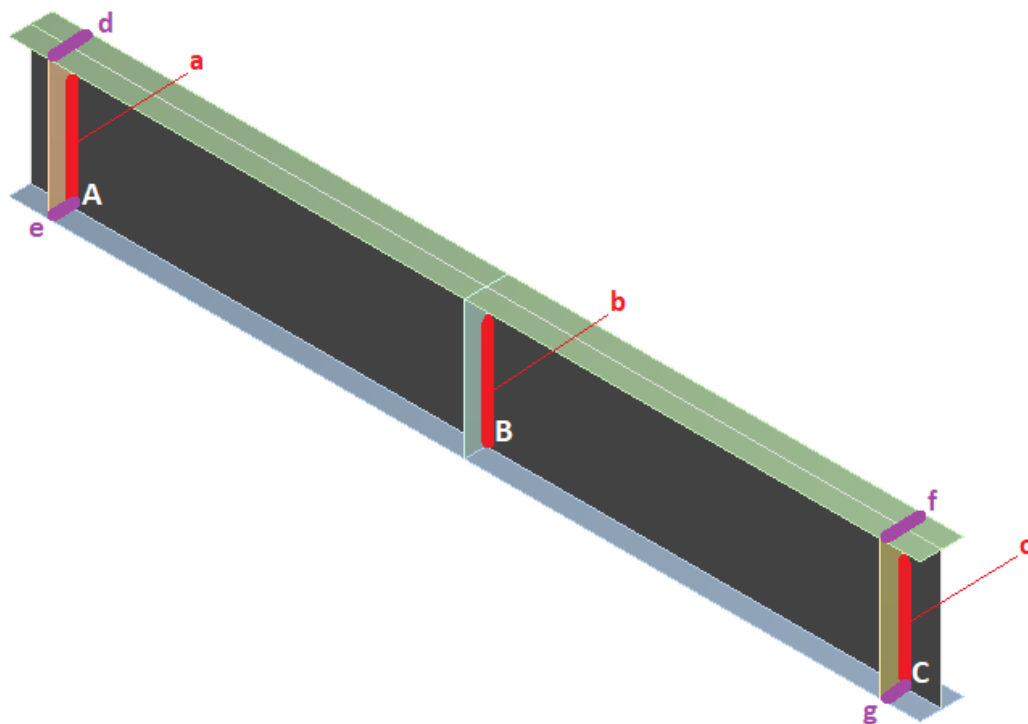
Vista de los elementos con limitaciones de movimiento en viga de alma plana
